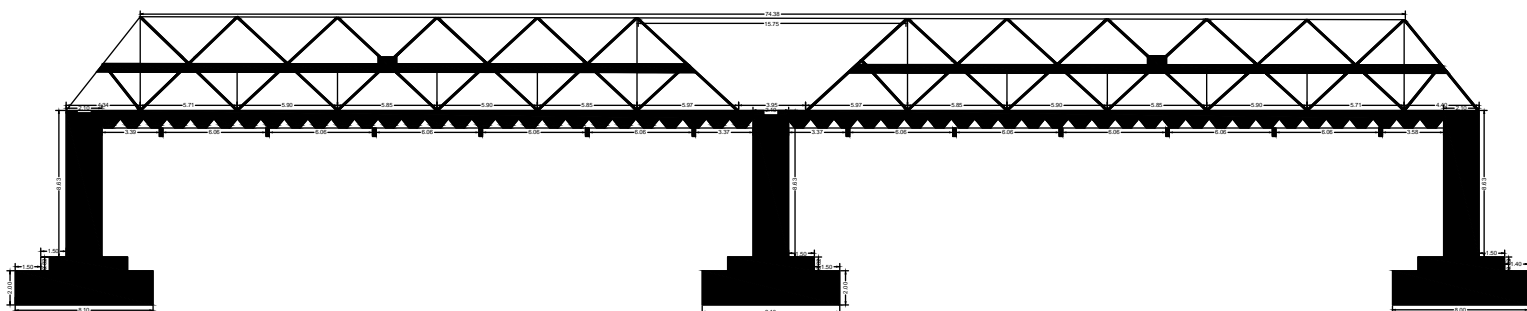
Plano alzado oeste puente Centenario carrera 5 Neiva-Huila.
